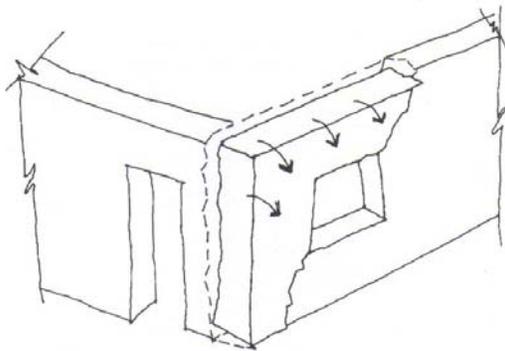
Ejemplo de inestabilidad local en un segmento de muro, entre fisuras.
